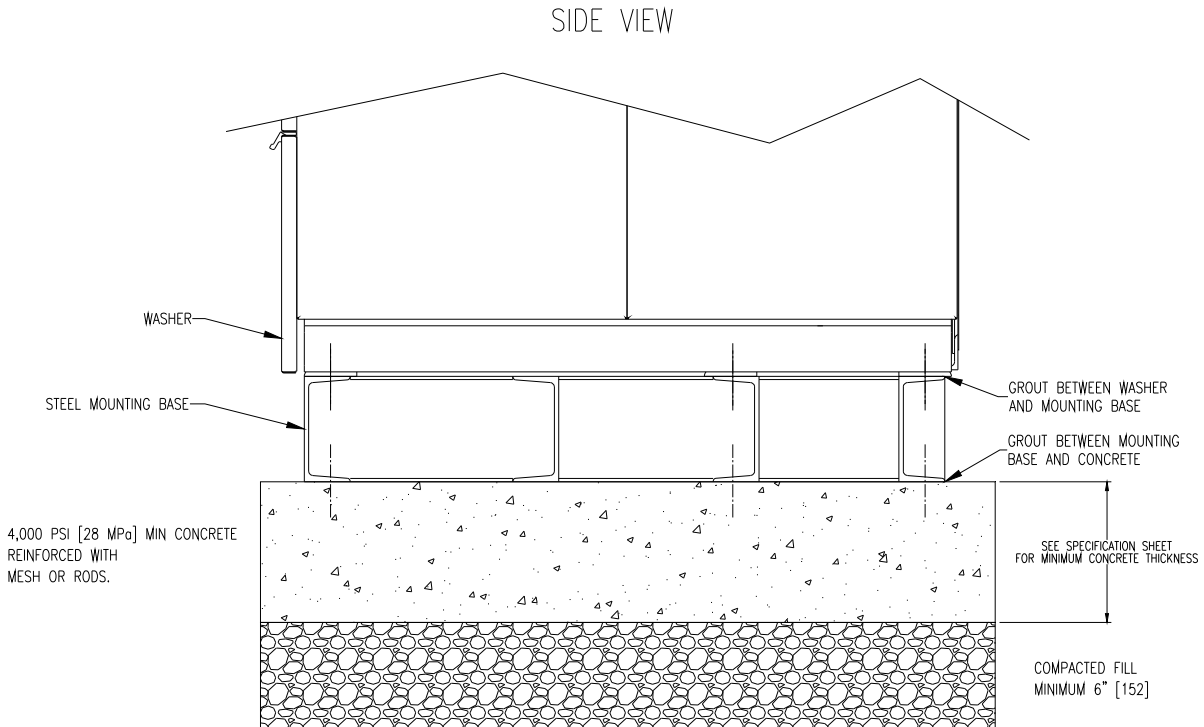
Base di montaggio in acciaio su pavimenti in calcestruzzo
